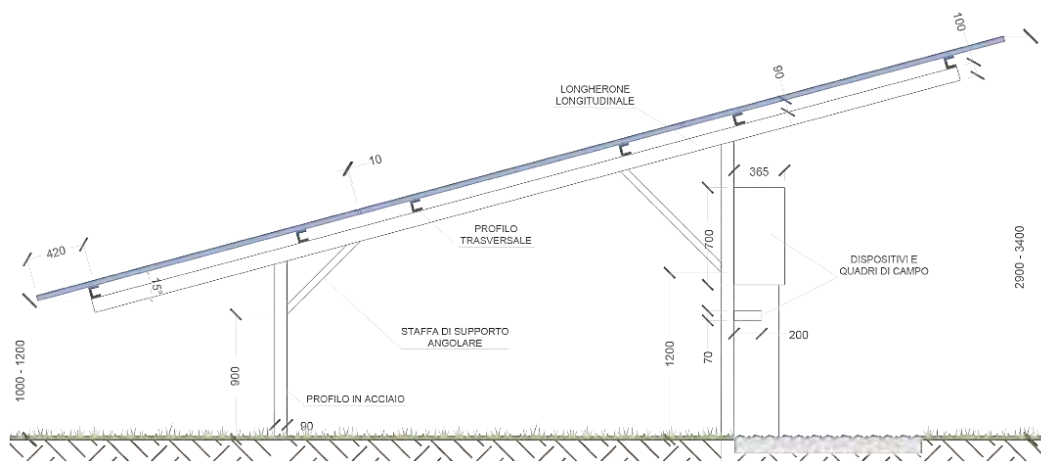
Schema di struttura fissa di progetto con moduli in silicio cristallino.
